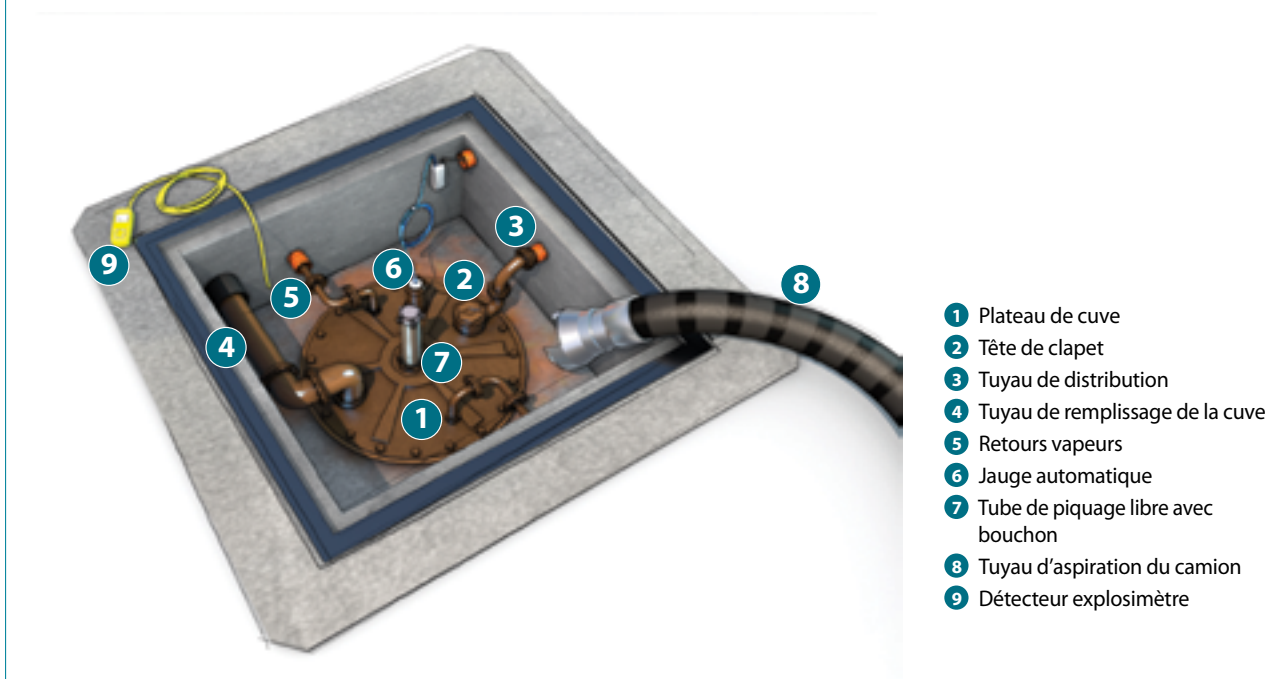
Vue d'ensemble des éléments d'un plateau de cuve avant son ouverture
